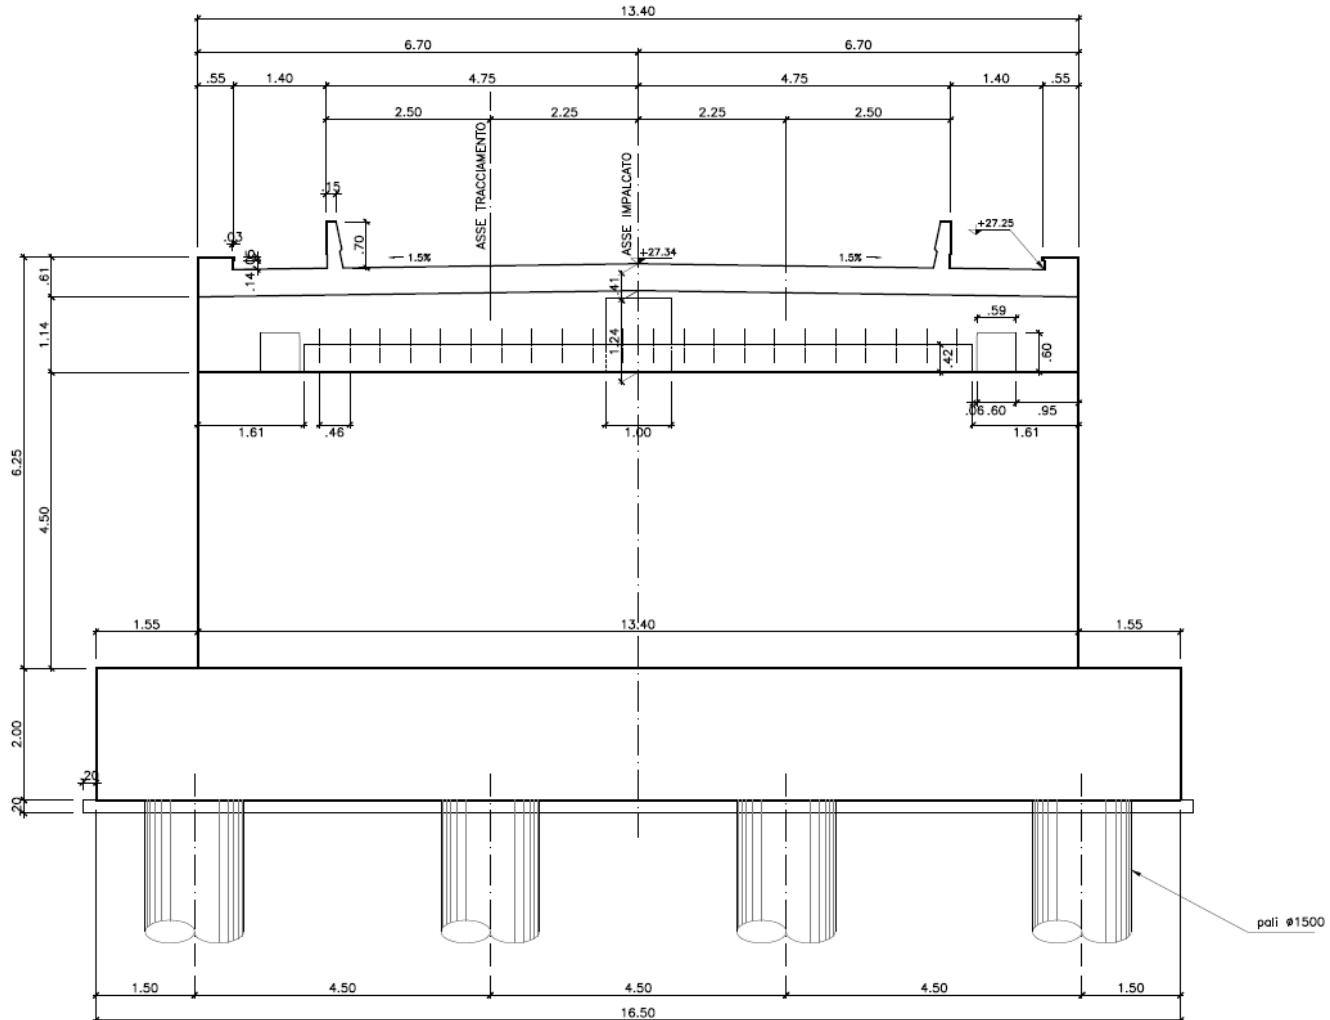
Prospetto frontale Spalla "A".
